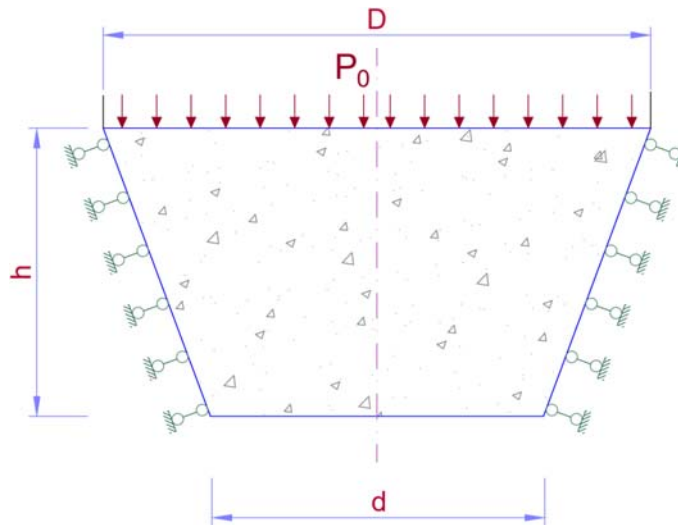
Расчетная схема бетонных ТЭ без шпонок
